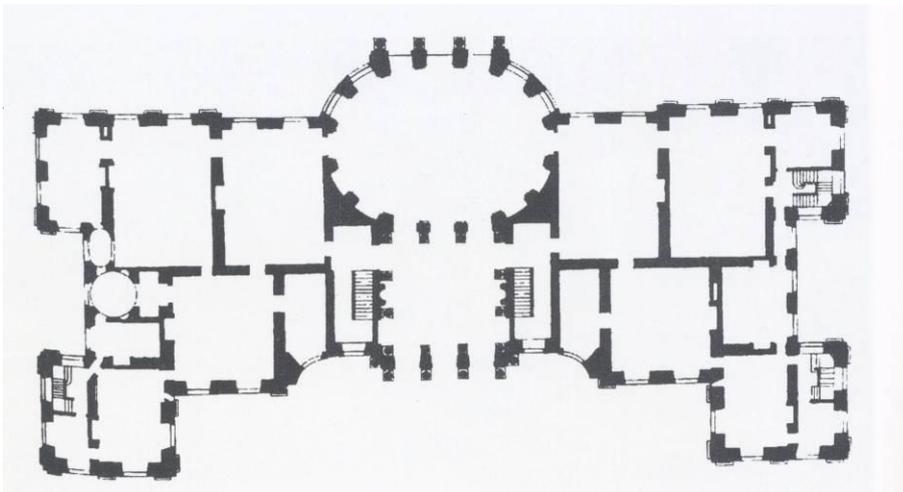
Vaux-le-Vicomte, Grundriss – Obergeschoss
